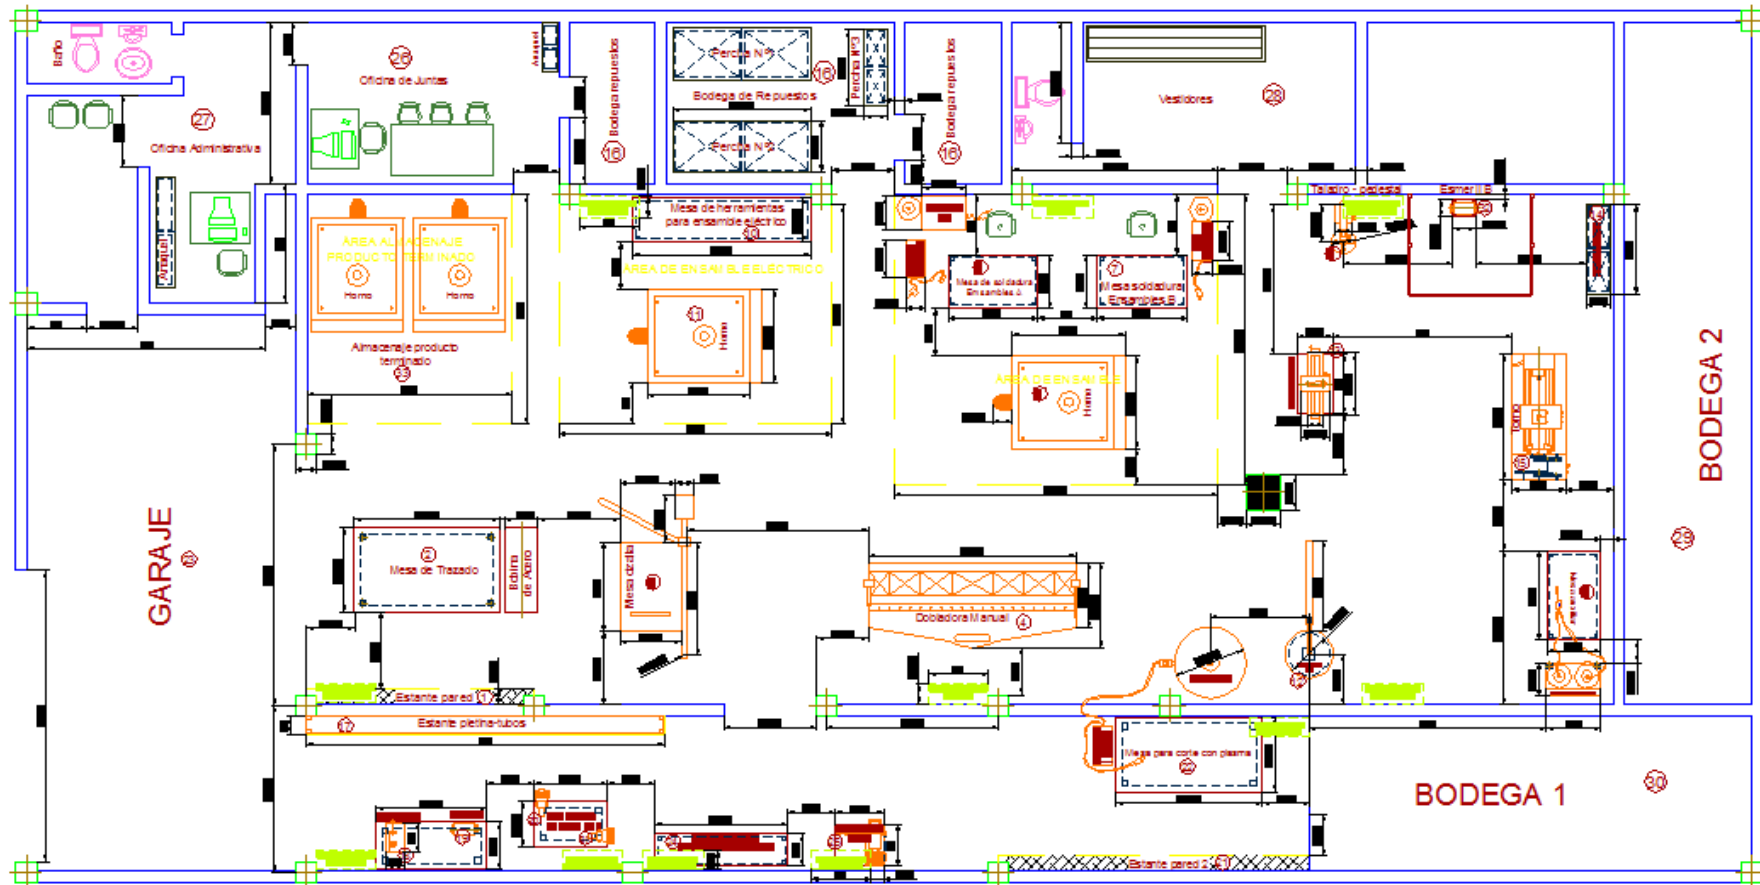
Distribución de planta propuesta, para mayor visualización ver plano completo en ANEXO 26
